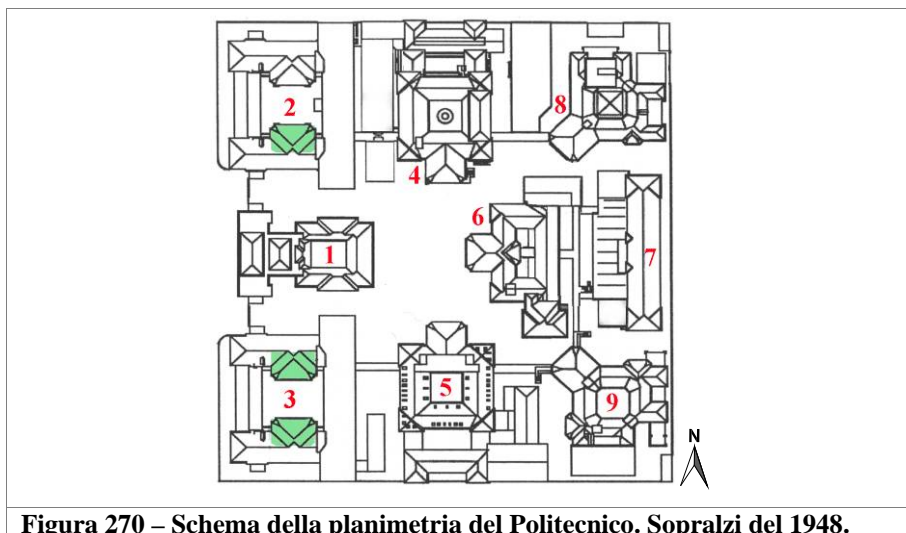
Schema della planimetria del Politecnico. Sopralzi del 1948.
